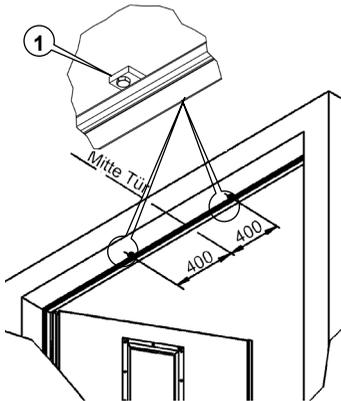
Befestigung der Oberzarge am Türsturz (Beispiel)
